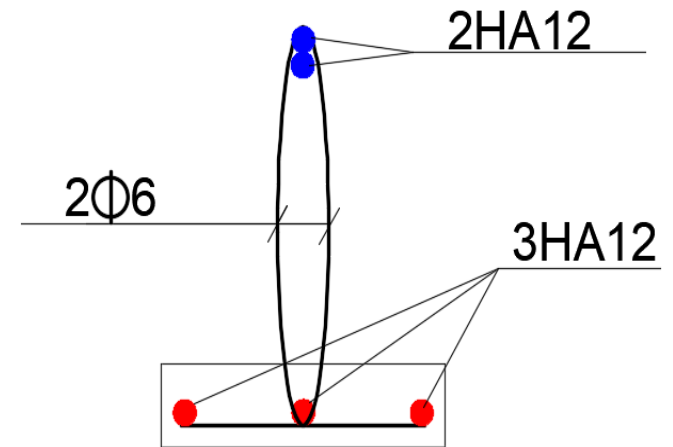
Ferrailage du plancher RDC ET 1^{er} étage.
